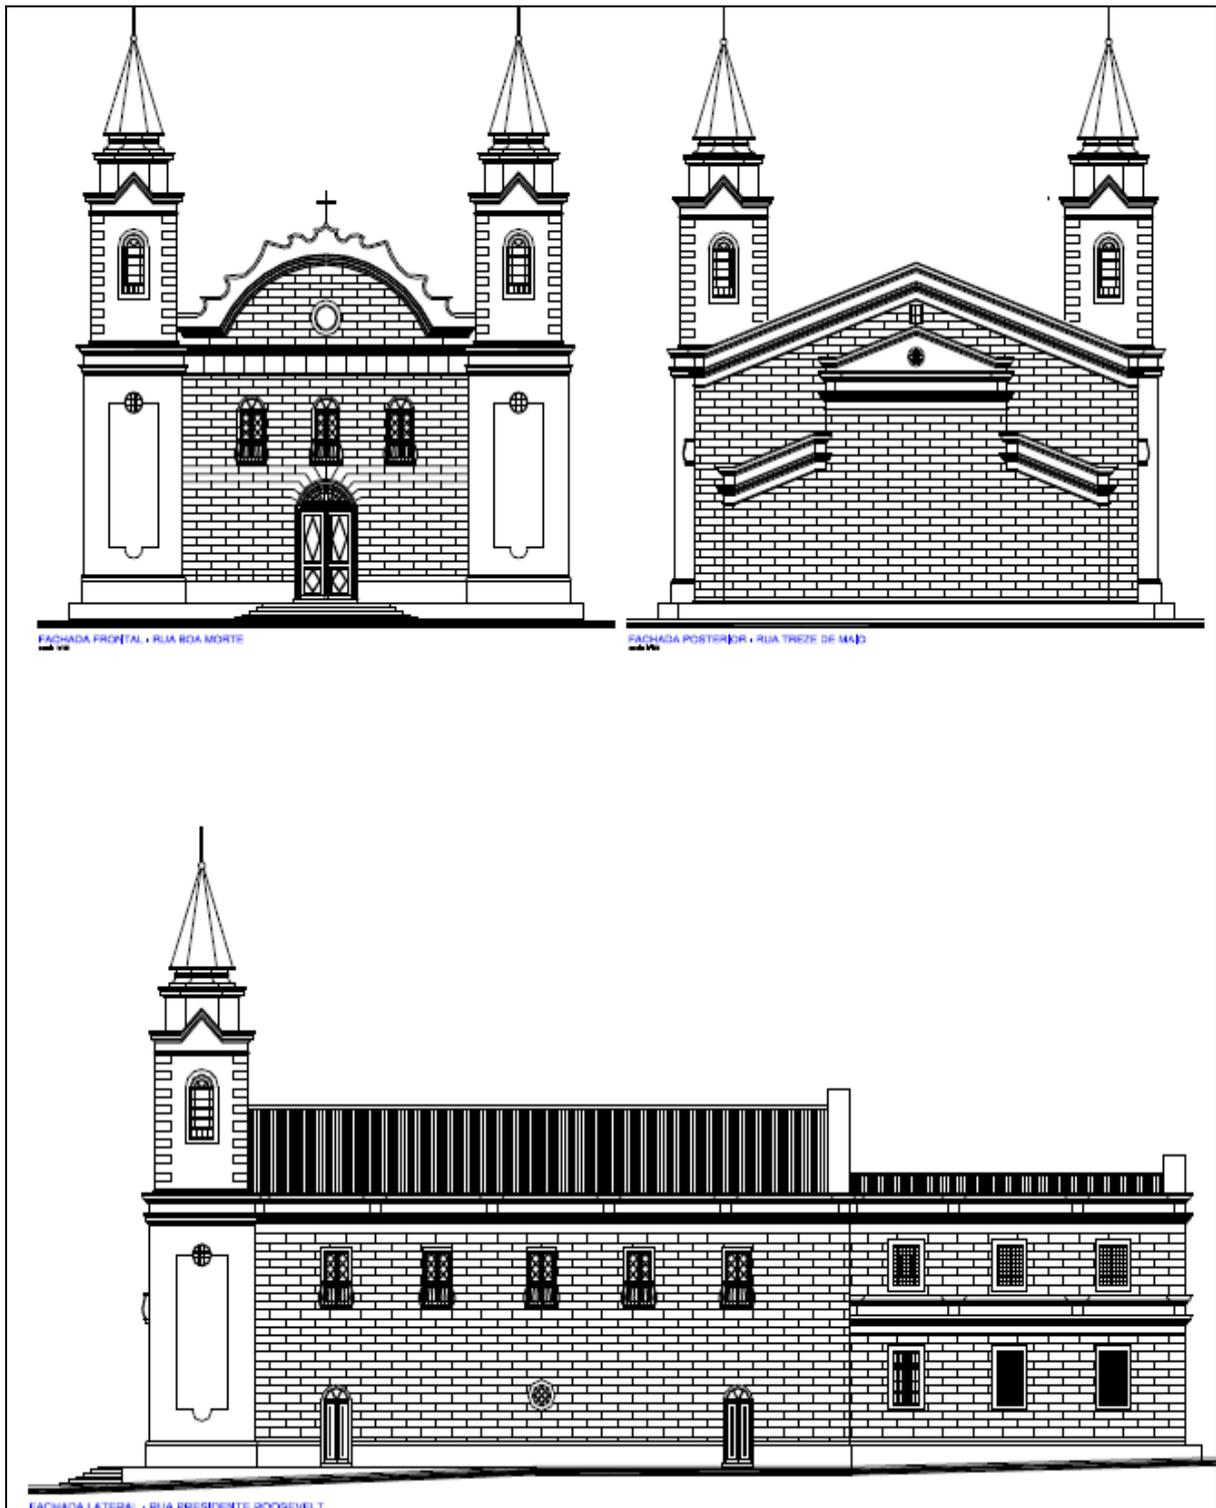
Croqui digitalizado da fachada frontal, fachada posterior e fachada lateral da igreja.
